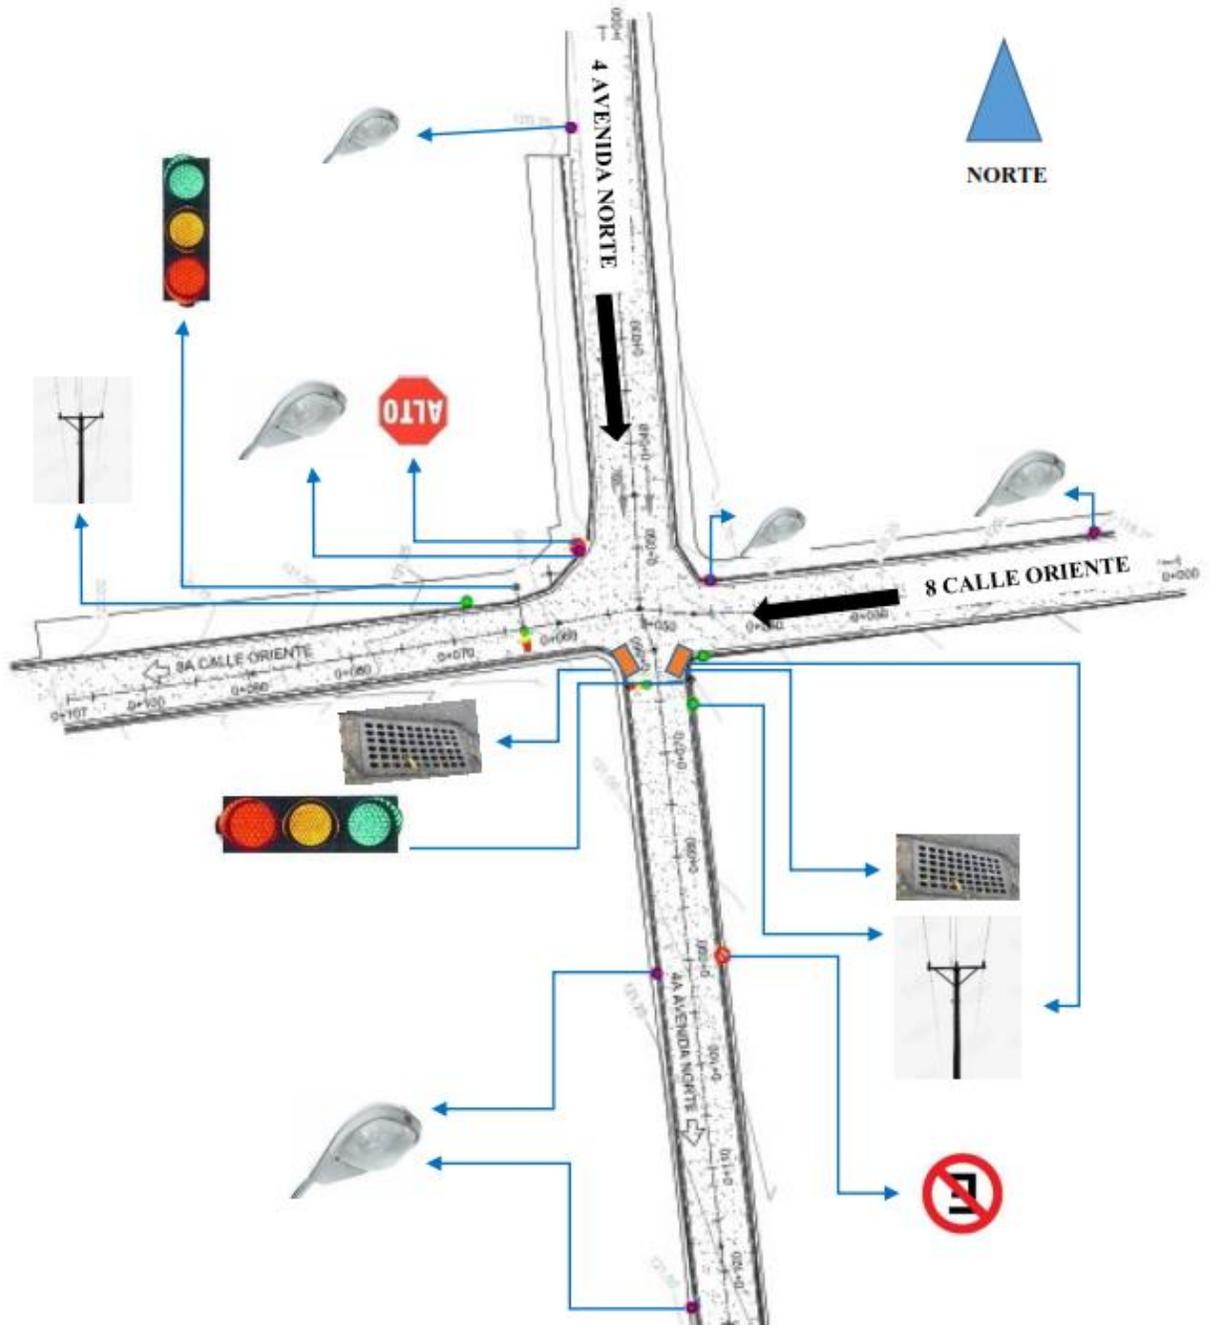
Detalles de la intersección Cuarta avenida norte con octava calle oriente.
